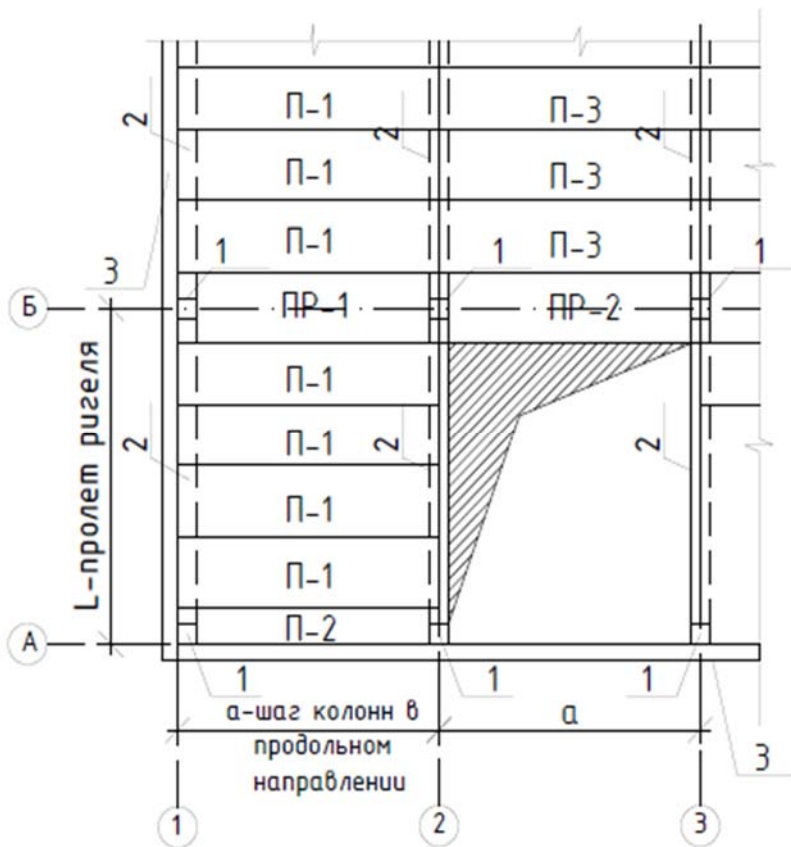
а. Раскладка сборных плит перекрытия с панелями-распорками:
